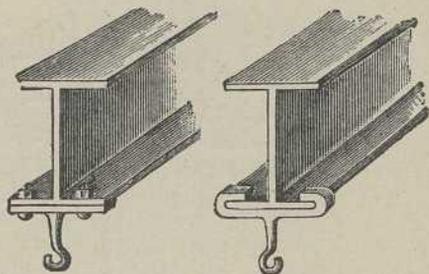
Vigas de hierro dotadas de ganchos para colocar el aparato de suspensión.
